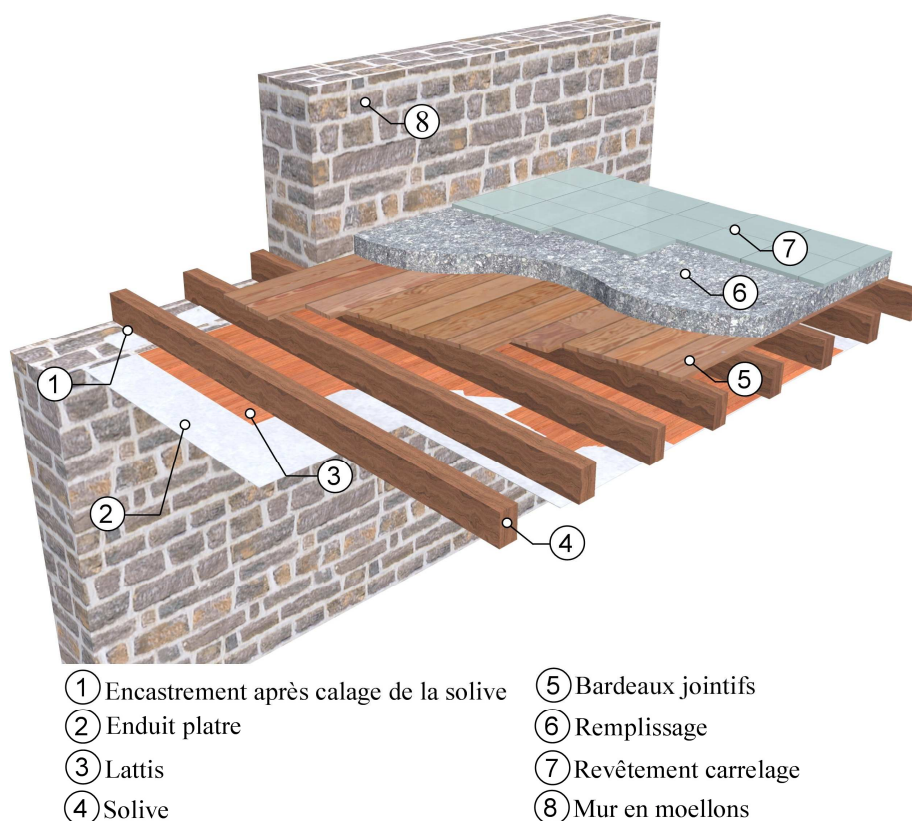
Plancher à ossature bois : cas des poutres encastées dans le mur.
